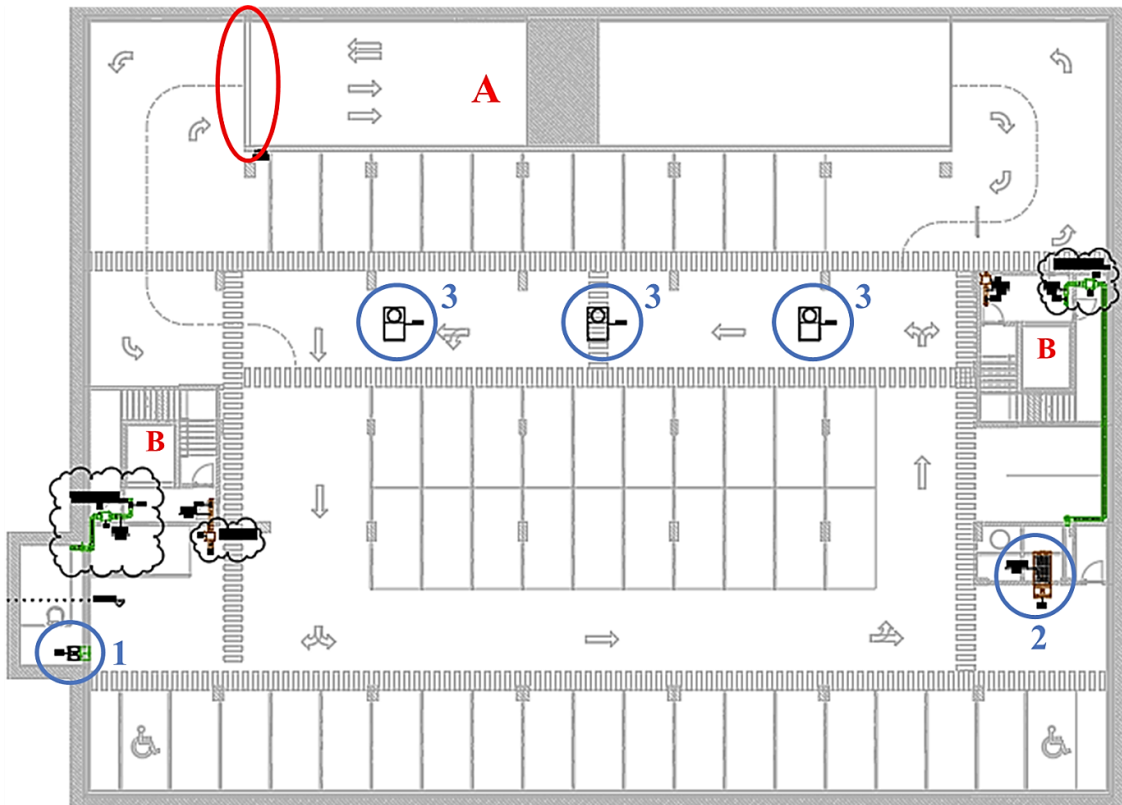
Layout* do piso -2: 1 – ventilador de insuflação, 2 – ventilador de extração, 3 – ventiladores de indução, A – rampa de ligação aos outros pisos, B – vias de evacuação vertical.
